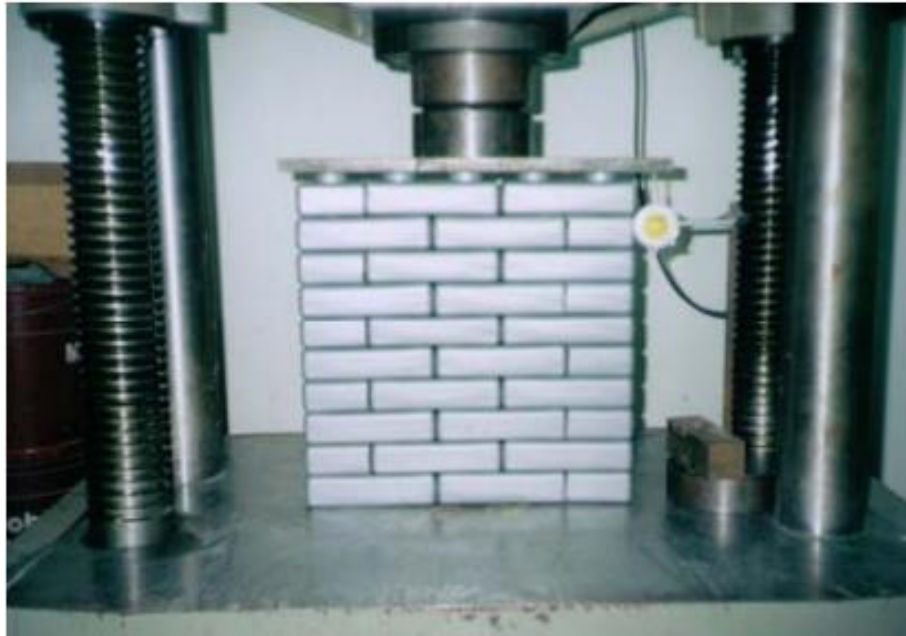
Muro de mampostería sometido a compresión. Fuente: (Id, 2010)
